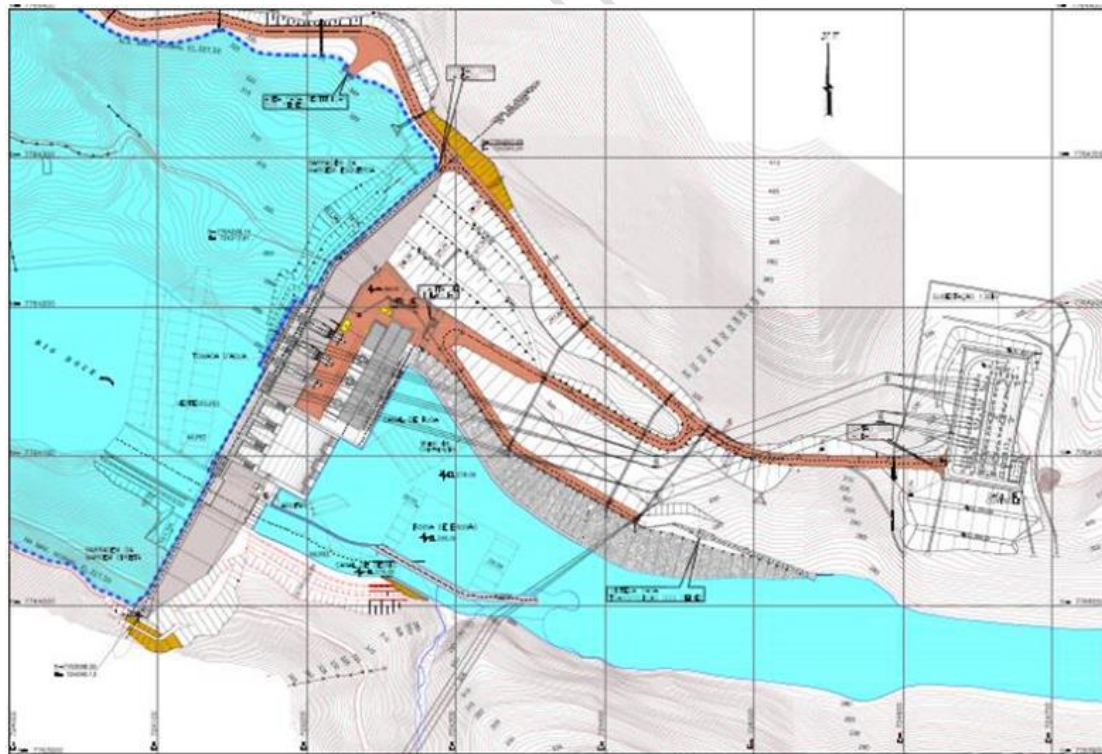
Arranjo geral da UHE Risoleta Neves - Planta. Fonte: desenho 437-10R-4651-05 (2001).
